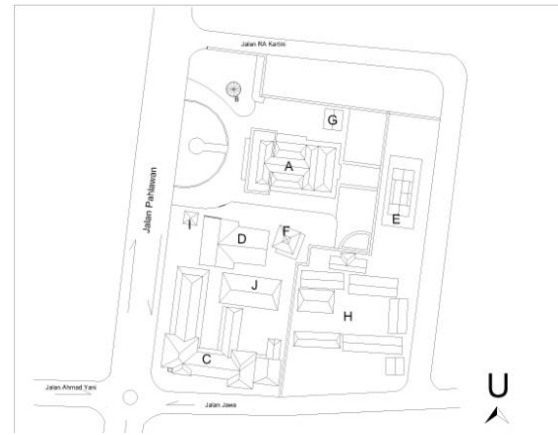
Orientasi ruang dalam bangunan rumah dinas Bakorwil
